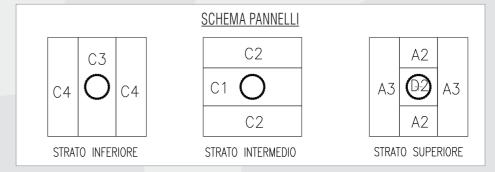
Disposizione dei moduli FAST SITE® SYSTEM 36
